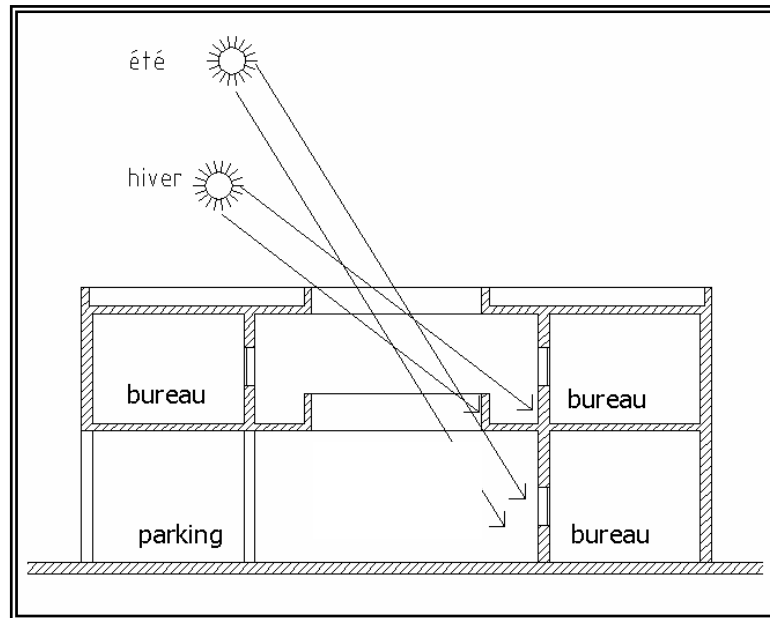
DSA, coupe transversale sur le puits d'éclairage
